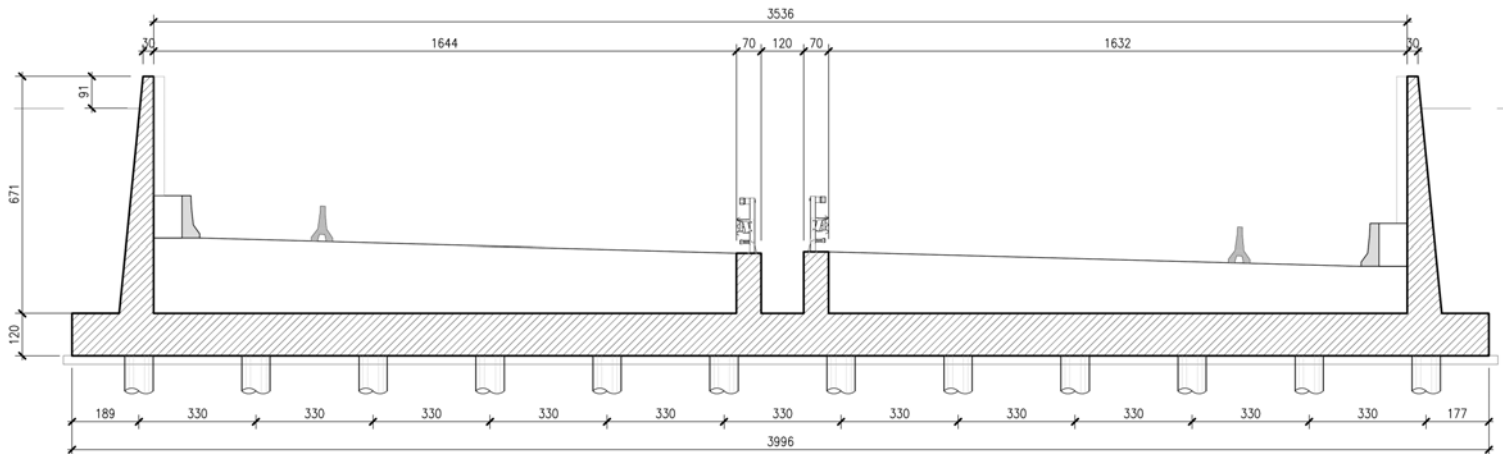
SEZIONE TRASVERSALE DI CALCOLO 2 (SEZIONE K28).
